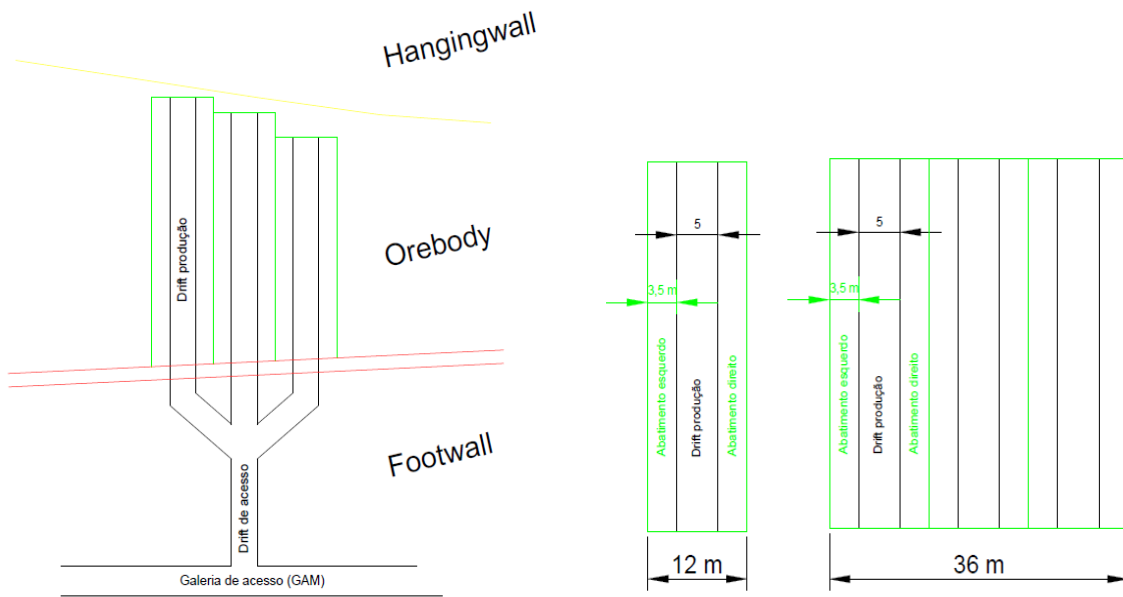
Esquematização em planta das larguras de bancada, em sistema individual e trifurcação previamente planeadas.
